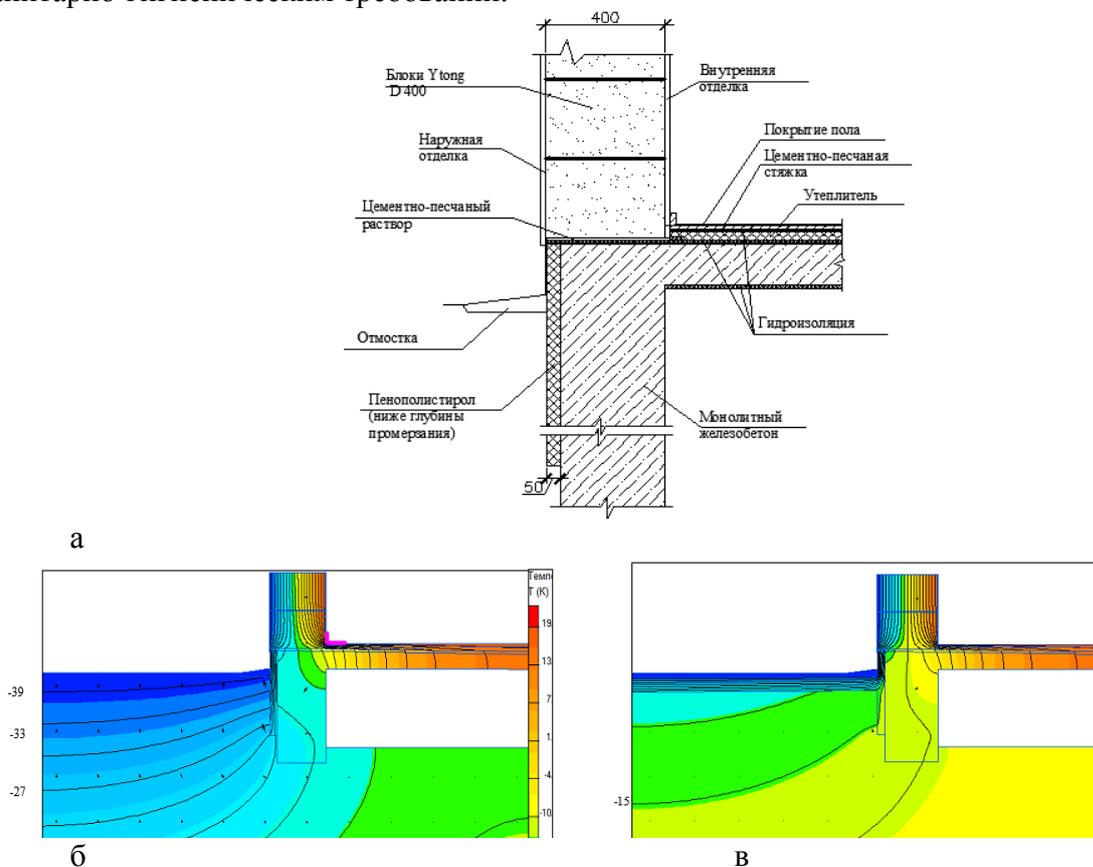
Узел примыкания стены к фундаменту и его расчет в программе Elcut: а – узел примыкания; б – тепловое поле узла (вариант 1); в – тепловое поле узла с теплоизоляционной юбкой (вариант 2)
